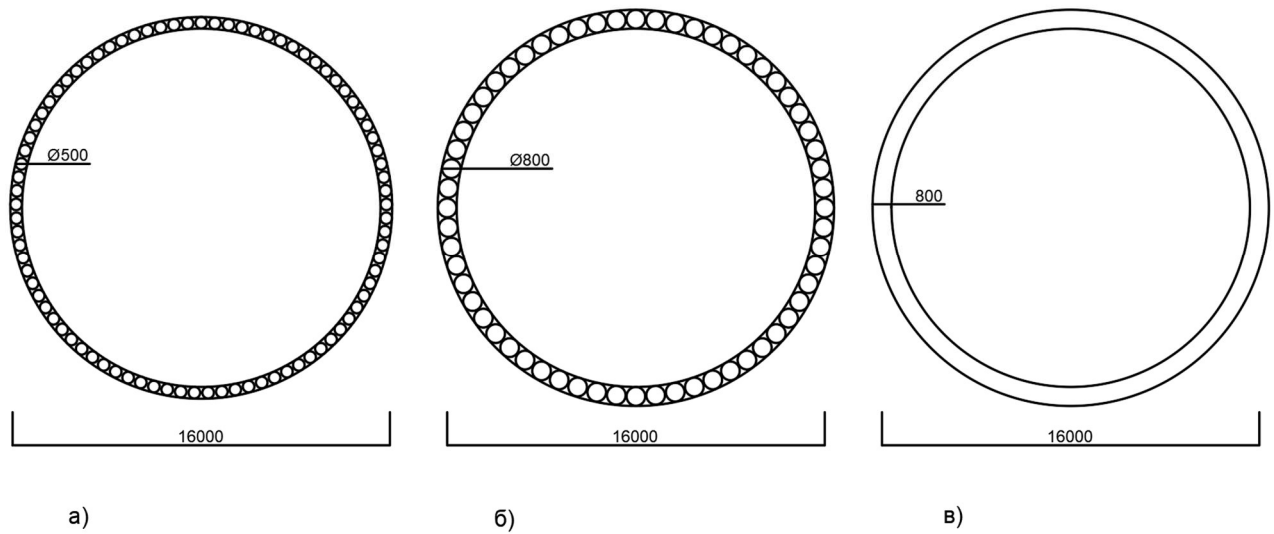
Схема розміщення паль та схема фундаменту з суцільної стінки :
